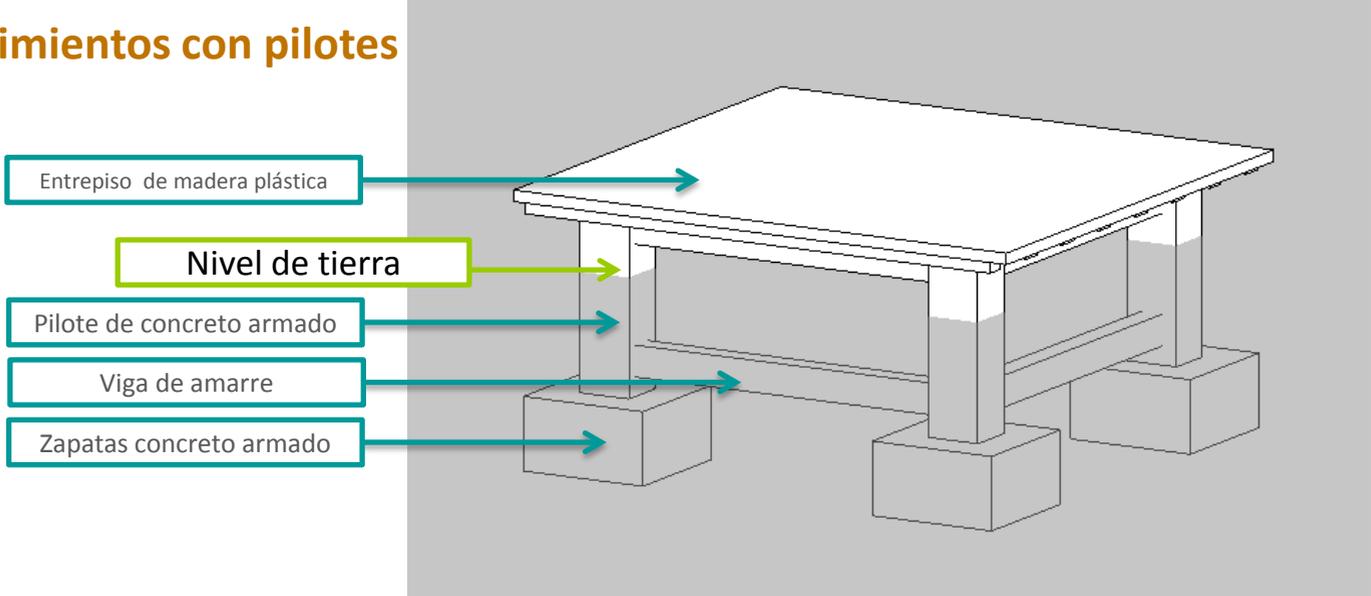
Cimientos sobre pilotes con vigas de amarre
